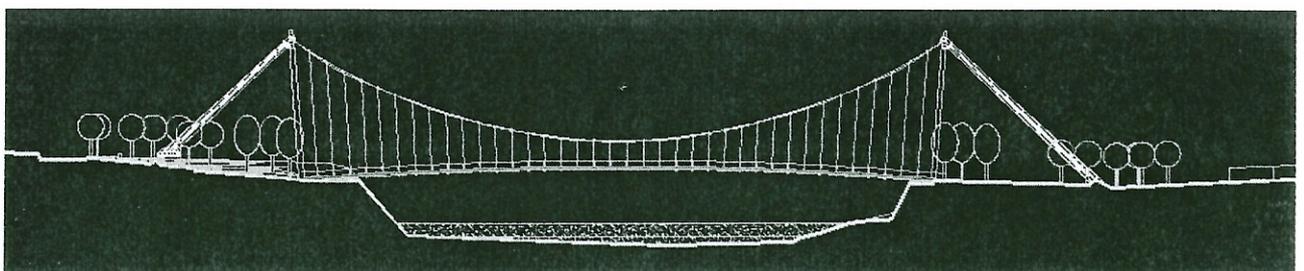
Fase 5: Installazione delle funi stabilizzanti, pretensionamento e finitura della pavimentazione in legno
